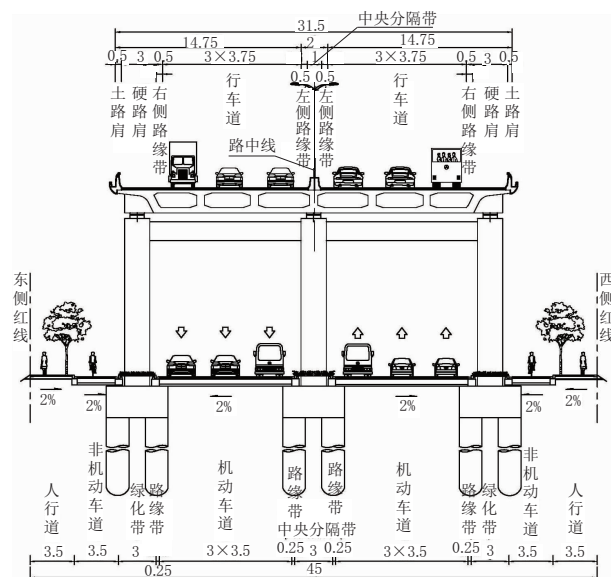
福宜高速城区段宽 45 m 标准横断面图(单位:m)
